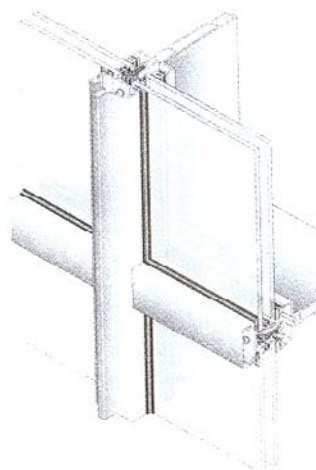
Muro cortina. (La fachada ventilada y ligera, Cristina Pardal / Ignacio Paricio)
